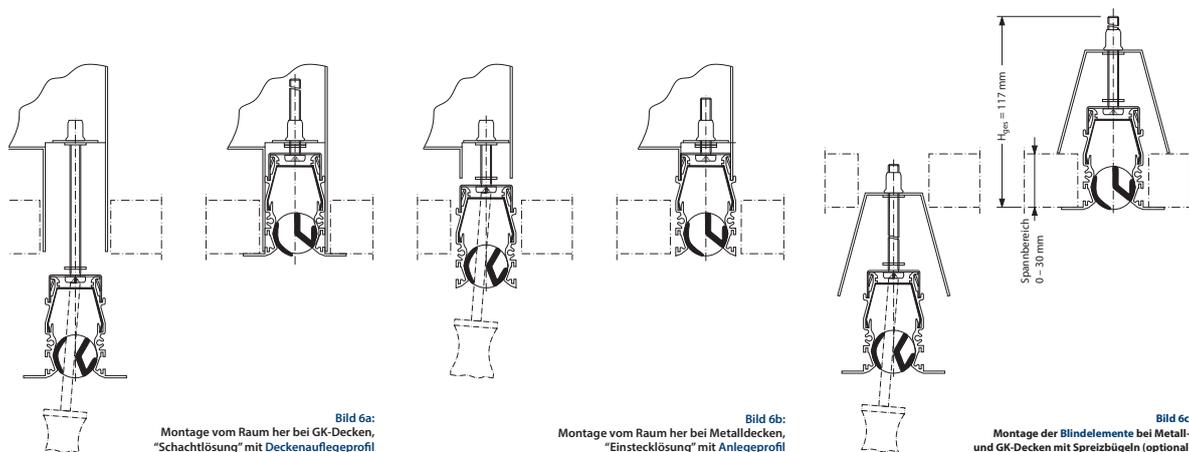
Montage vom Raum her bei GK-Decken, "Schachtlösung" mit Deckenauflegeprofil
